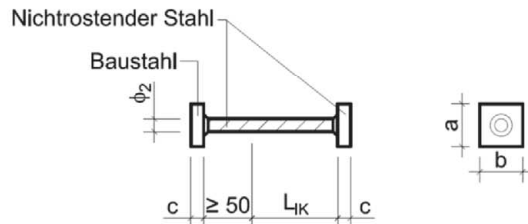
Druckelement aus Stahl mit angeschweißten Druckplatten, einseitig bündig, einseitig min. 50 mm einbindend (bspw. für Schöck Isokorb® Typ K-ID, Schöck Isokorb® RT Typ K)
